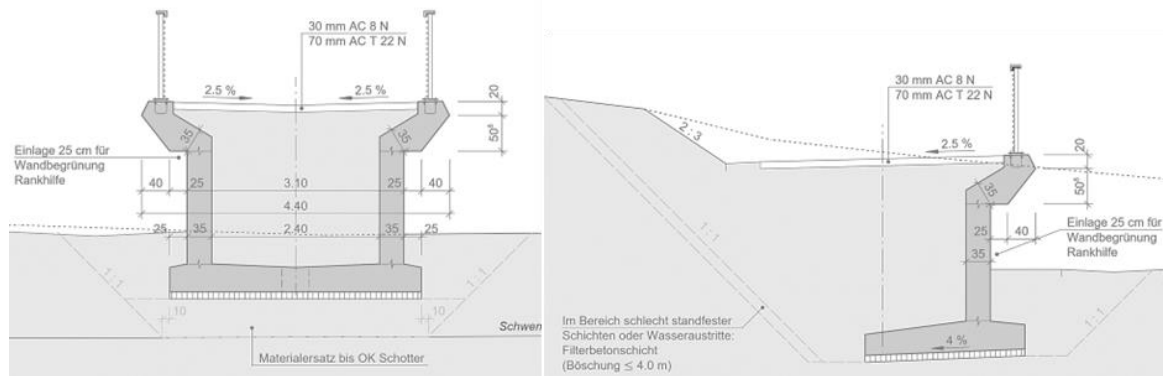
Querschnitt Rampe, links Rampe Ost, rechts Rampe West
